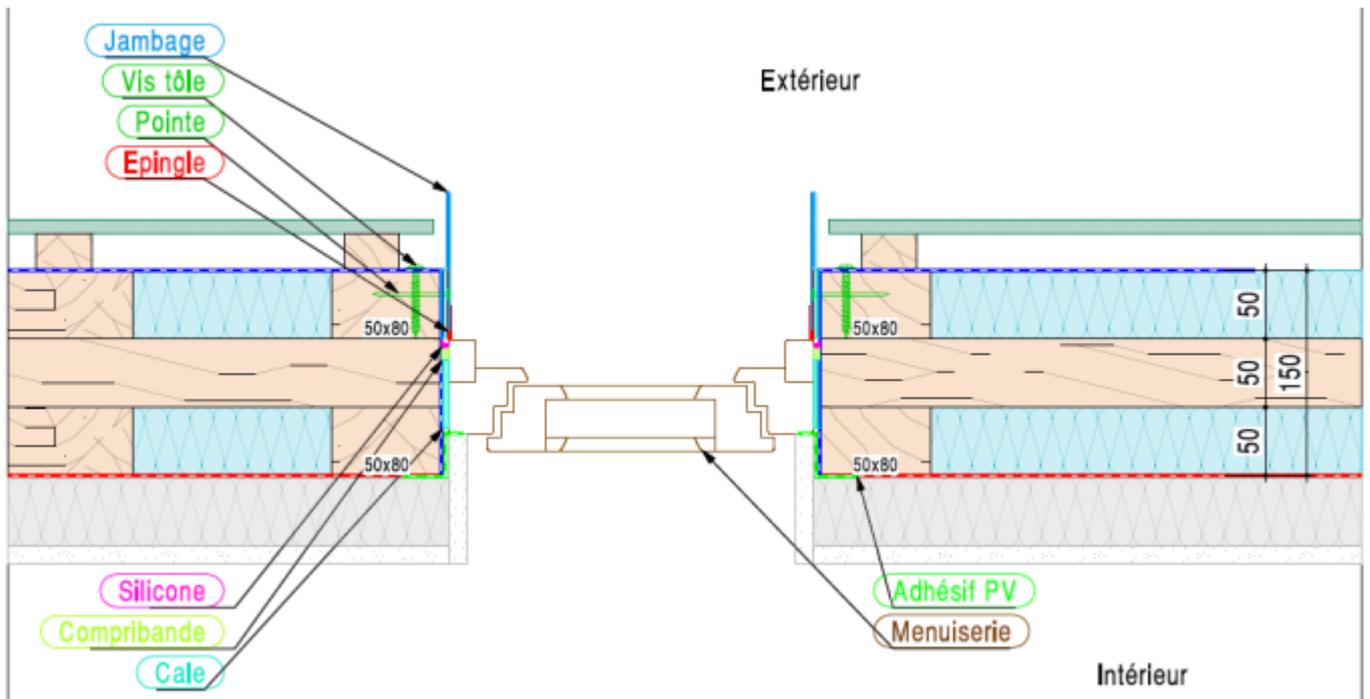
Menuiserie en tunnel / Coupe horizontale
